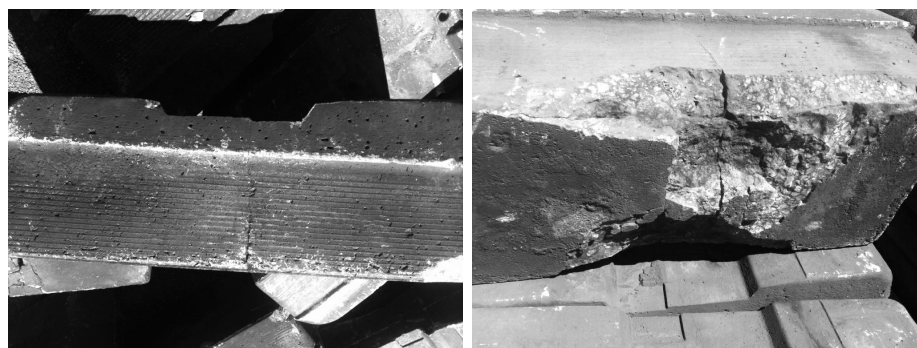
Dégradation du blochet : fissuration verticale (à gauche) et fissuration horizontale avec la rupture d’une partie inférieure (à droite)
